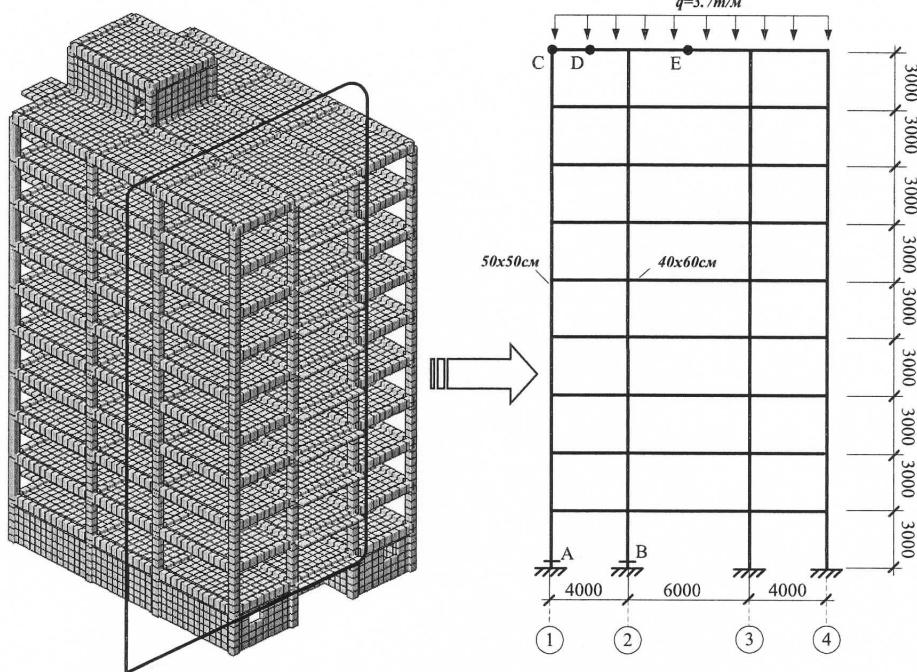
Расчетная схема 9-ти этажного монолитного здания
